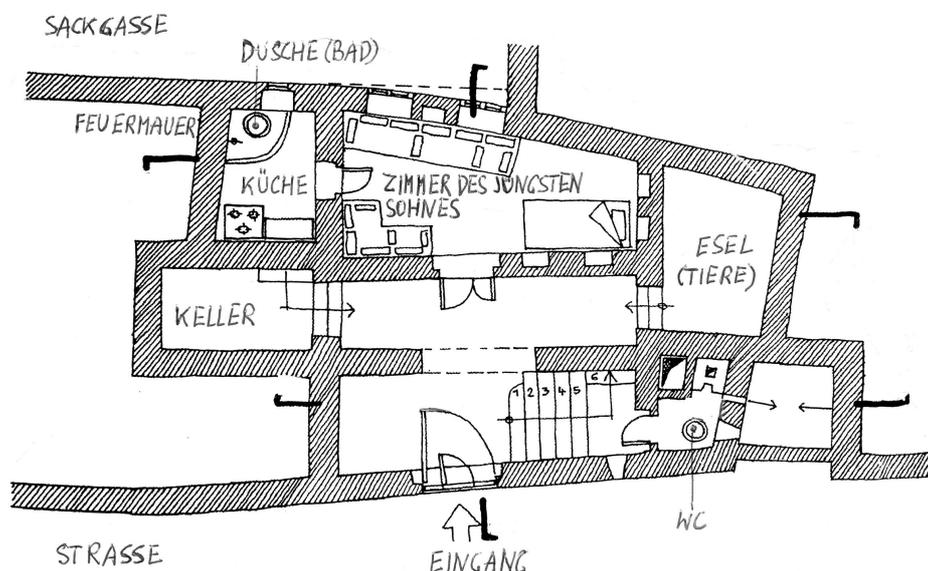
Grundriss des Erdgeschoßes des Hauses
